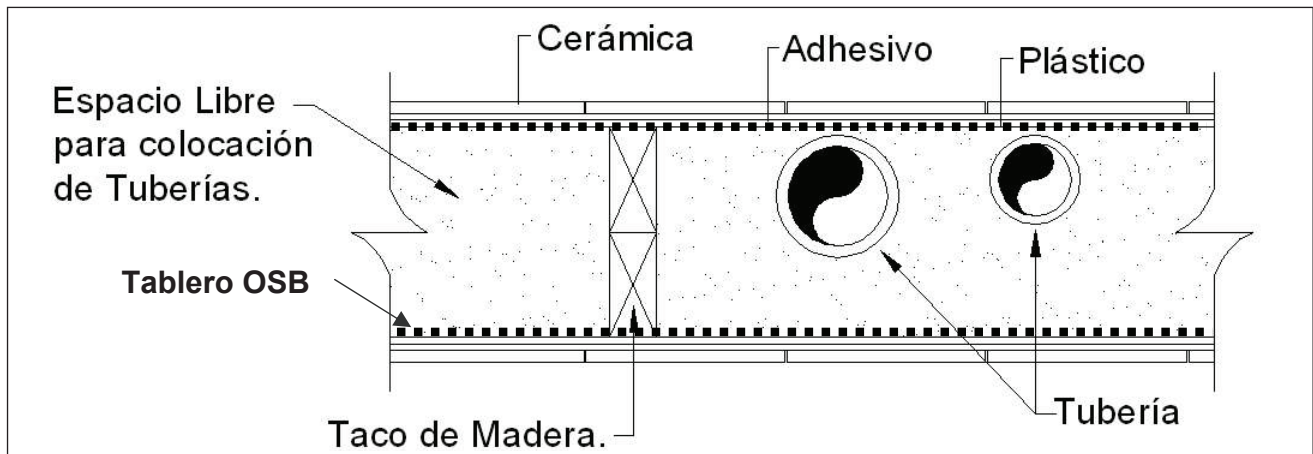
Detalle constructivo de la consideración del panel técnico de las instalaciones de aguas servidas y potables de los baños, cocinas y servicios de las casas con madera. Fuente: elaboración propia.
